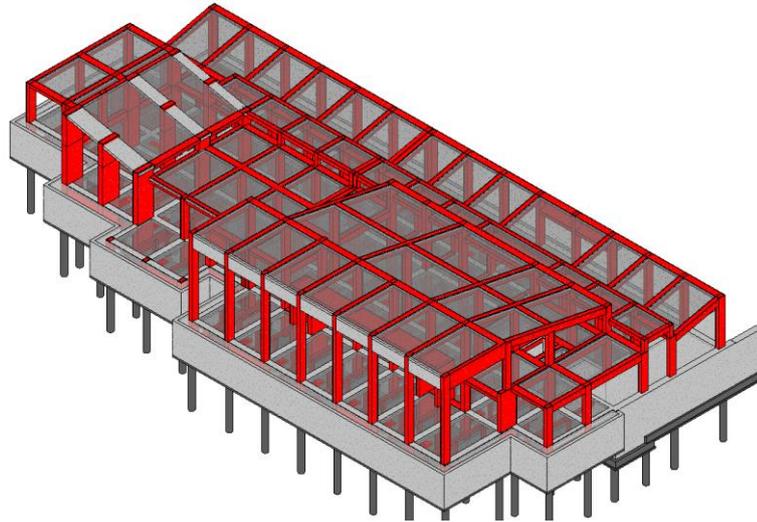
Distribuzione delle incamicature armate su travi e pilastri
